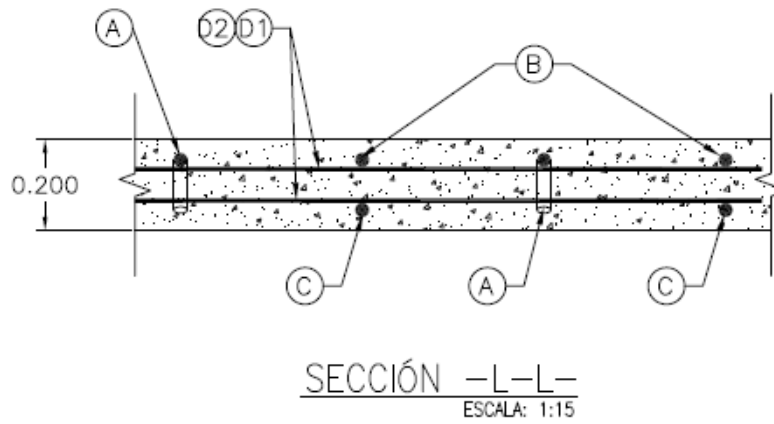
Sección longitudinal de losa puente espesor 20 cms.
